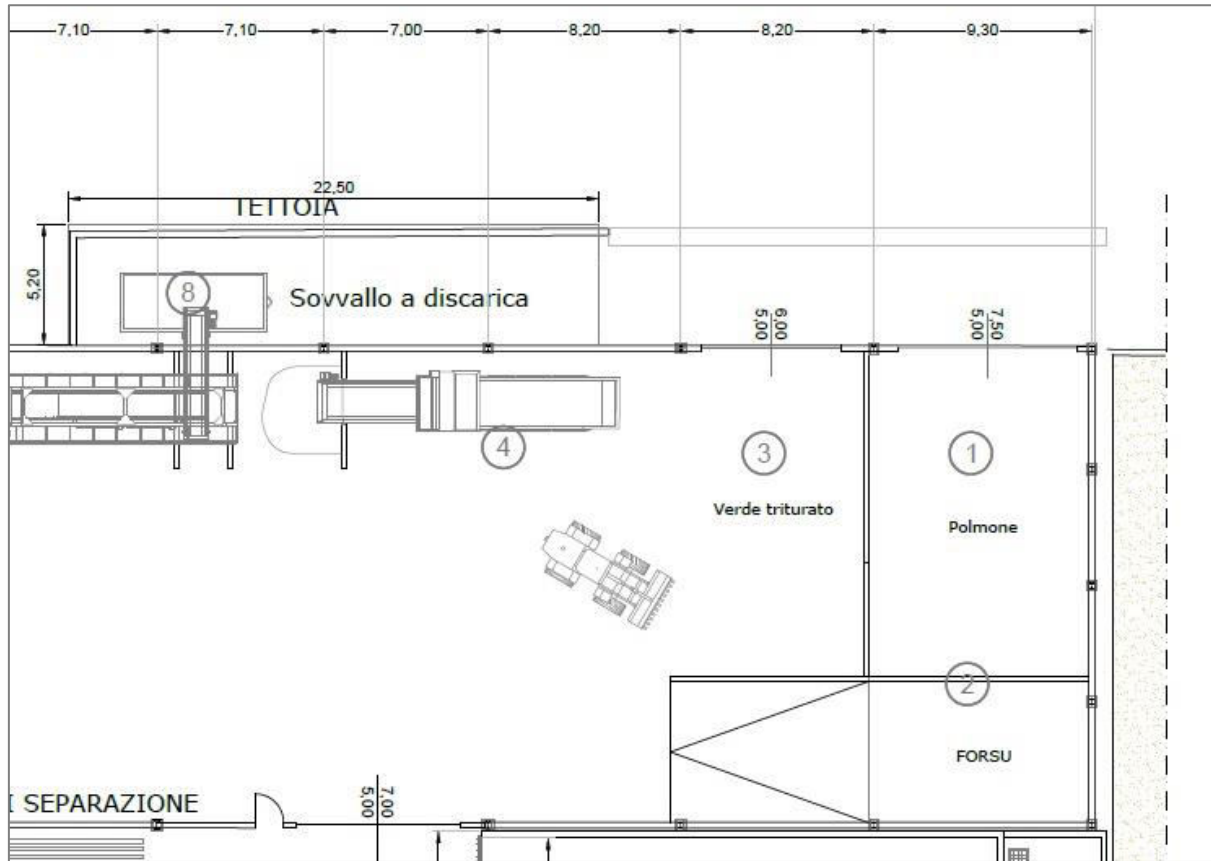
PIANTA DI DETTAGLIO – AREA DI RICEZIONE nella configurazione di progetto
